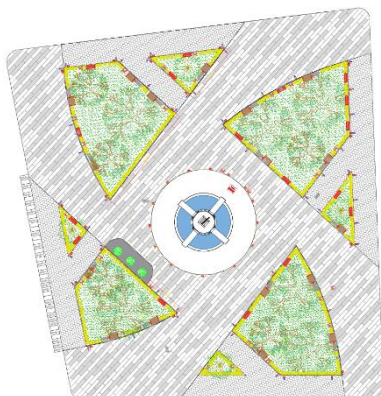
Planta general de la Plaza Mayor de Changuillo.
